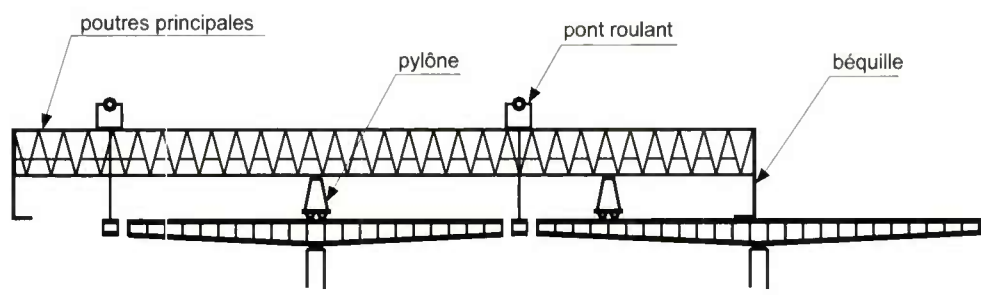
Principaux Éléments constitutifs d'une poutre de lancement
